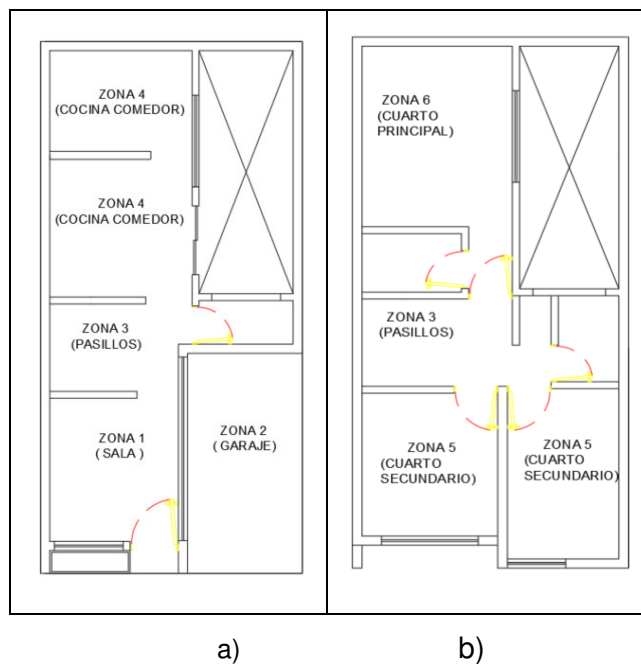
Distribución de zonas térmicas; a) Planta Baja, b) Planta Superior
